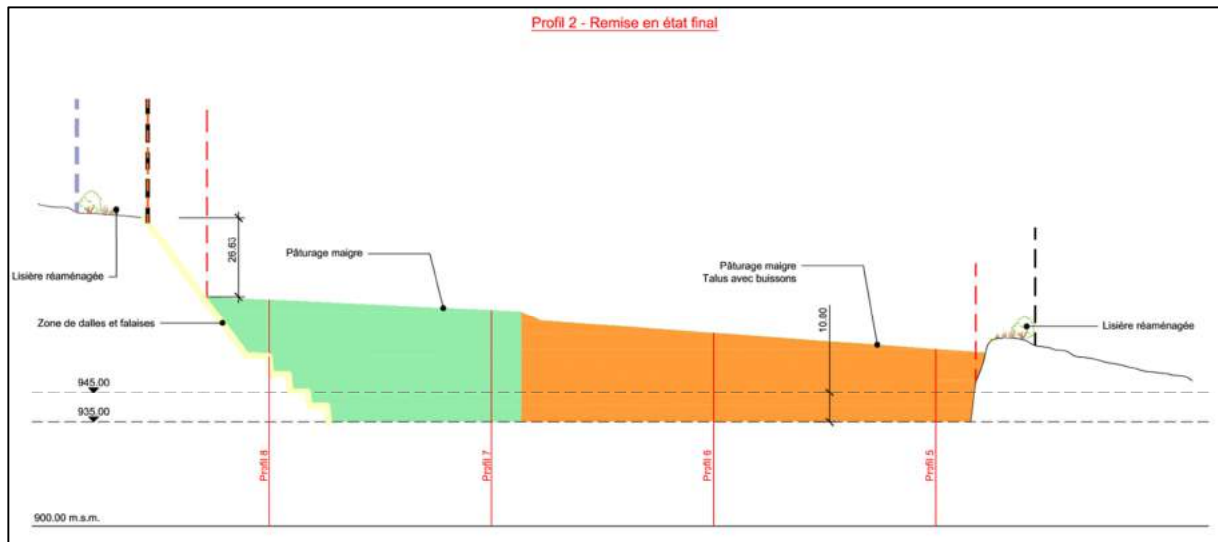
Coupe type de remise en état final – Profil 2 (source : ATB SA)
